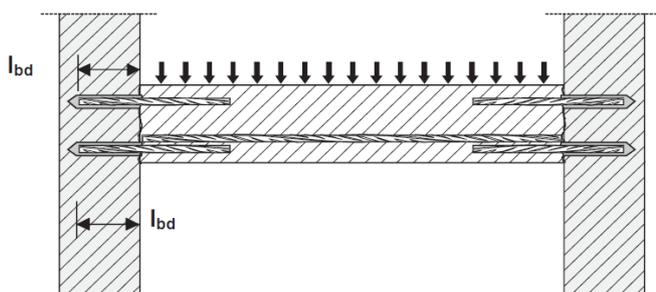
Joint de recouvrement pour l'assemblage de plaques ou de poutres
